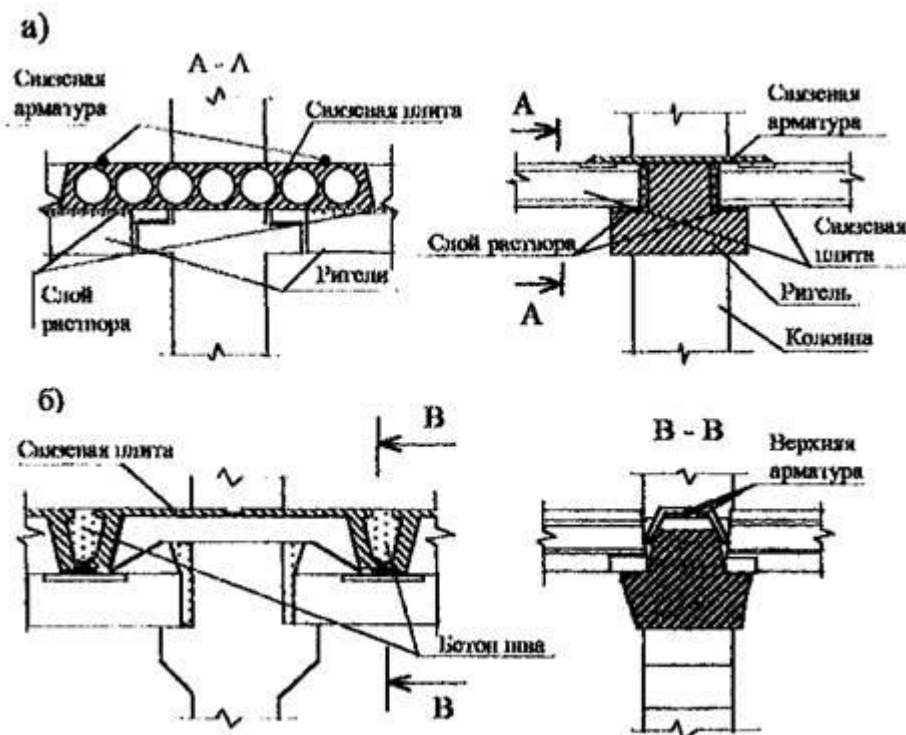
Узел сопряжения связевых многопустотных (а) и ребристых плит (б) с ригелем
